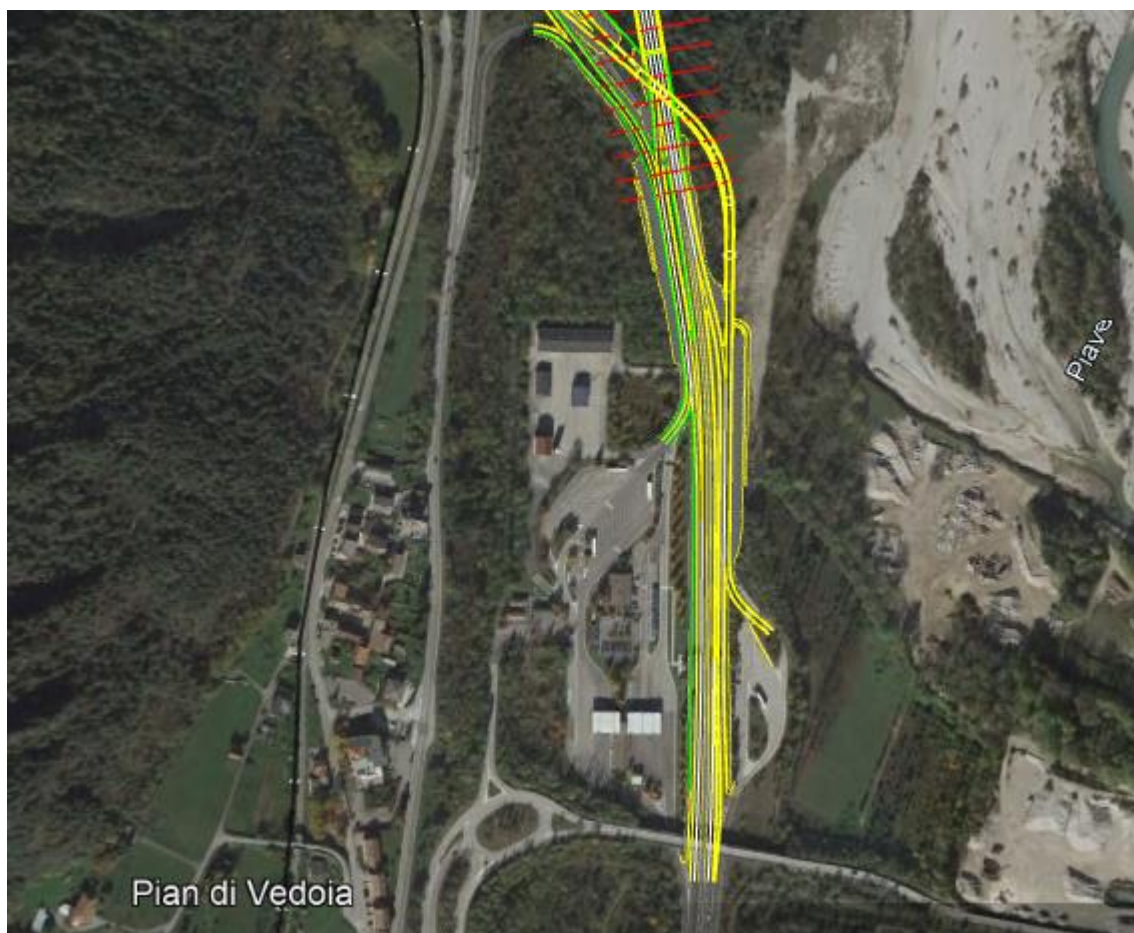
Stralcio Figura 6.3-4 Planimetria delle Figure: 2.2.1 – Immagini da Google Earth in corrispondenza delle progressive pK0+000 e PK 1+020
